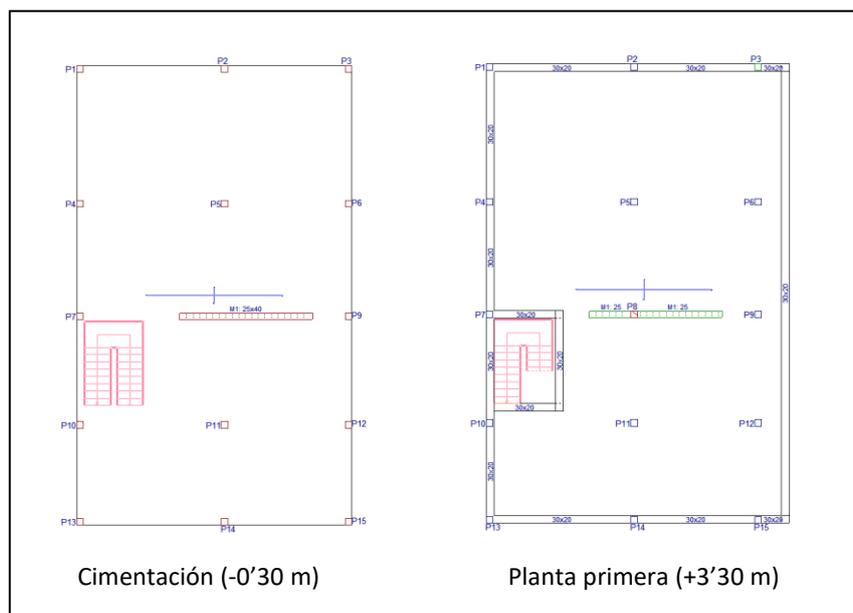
Recorte de pantalla, Vistas plantas con núcleo de escaleras en Cypecad
